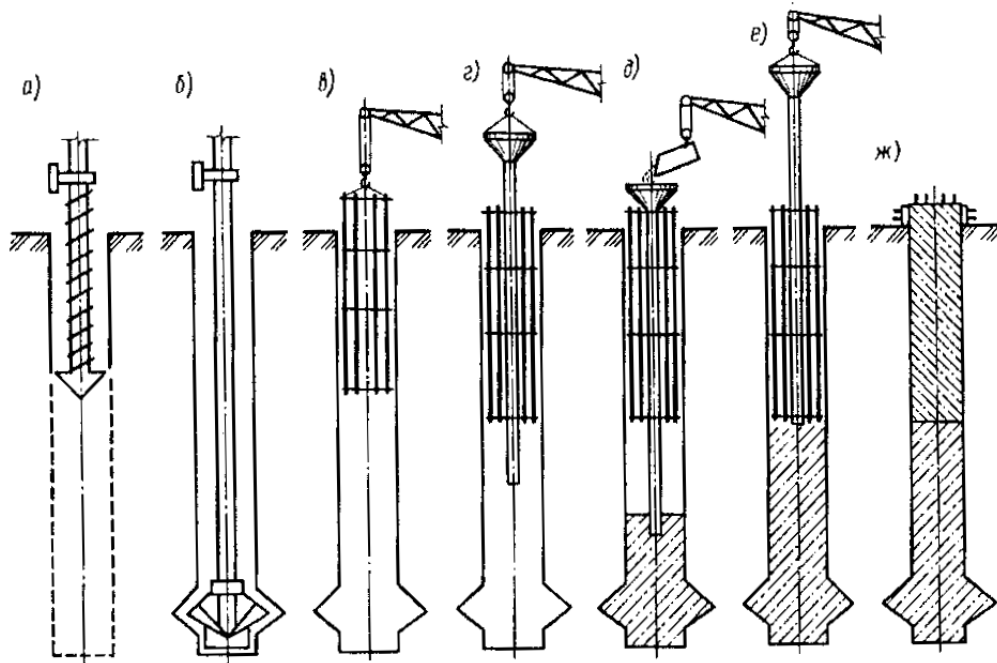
Послідовність виготовлення буронабивних палі без оболонок: а – буріння свердловини; б – влаштування розширення механічним способом (і не тільки); в – встановлення арматурного каркаса; г – опускання в свердловину бетонолитної труби; д – заповнення свердловини бетонною сумішшю; е – витягання бетонолитної труби з вібрацією; ж – формування голови палі в інвентарному кондукторі
